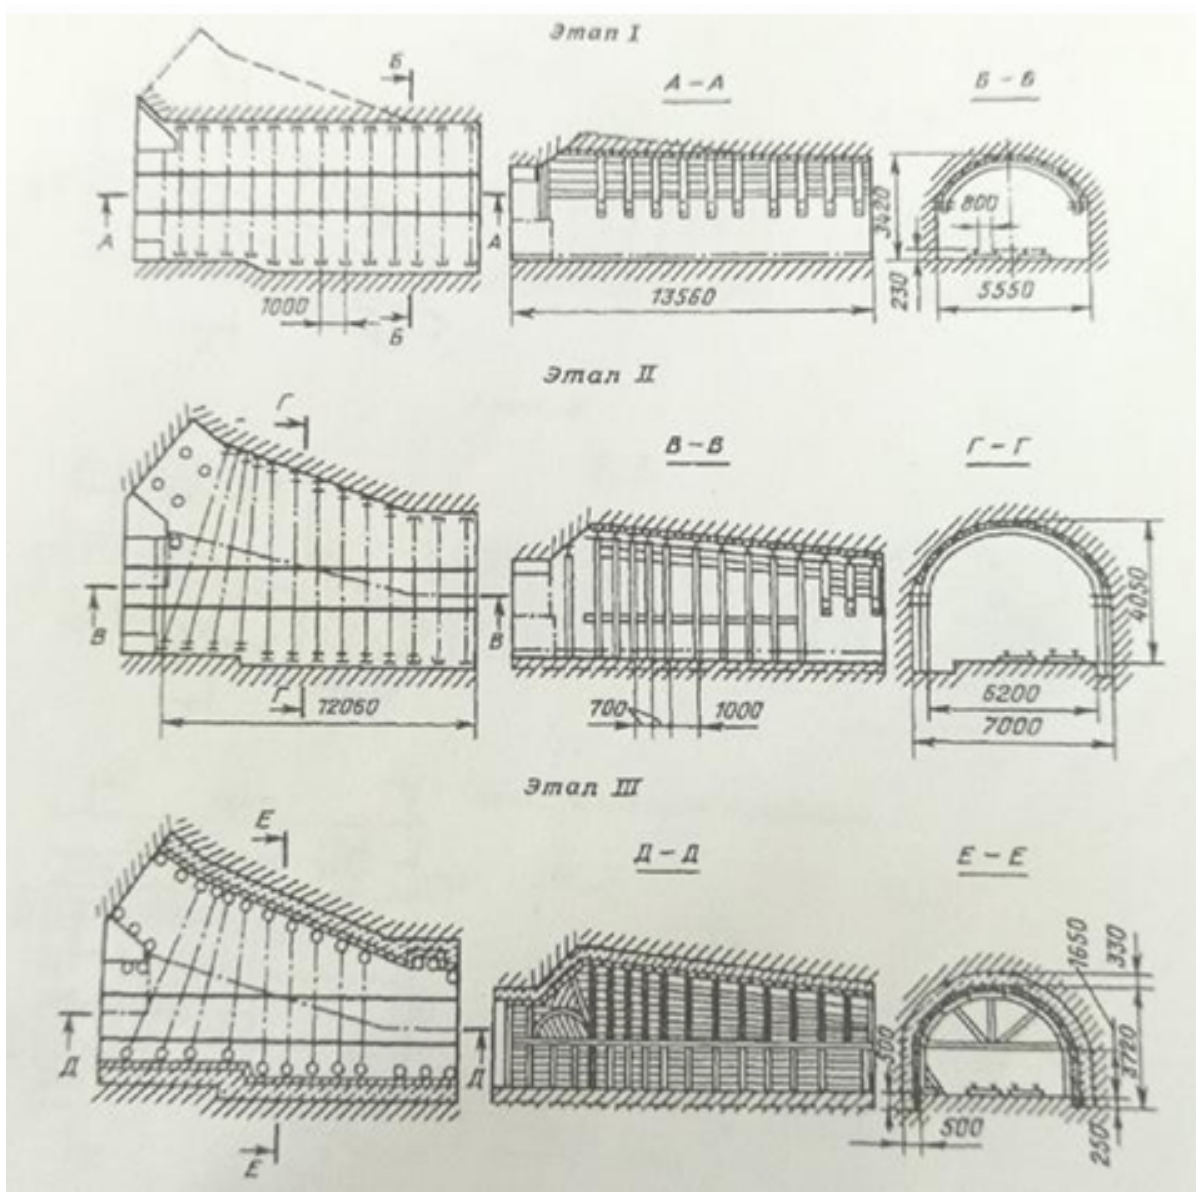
Схема строительства сопряжения сечением одной из примыкающих выработок с последующим расширением до проектных размеров со стороны основной выработки
